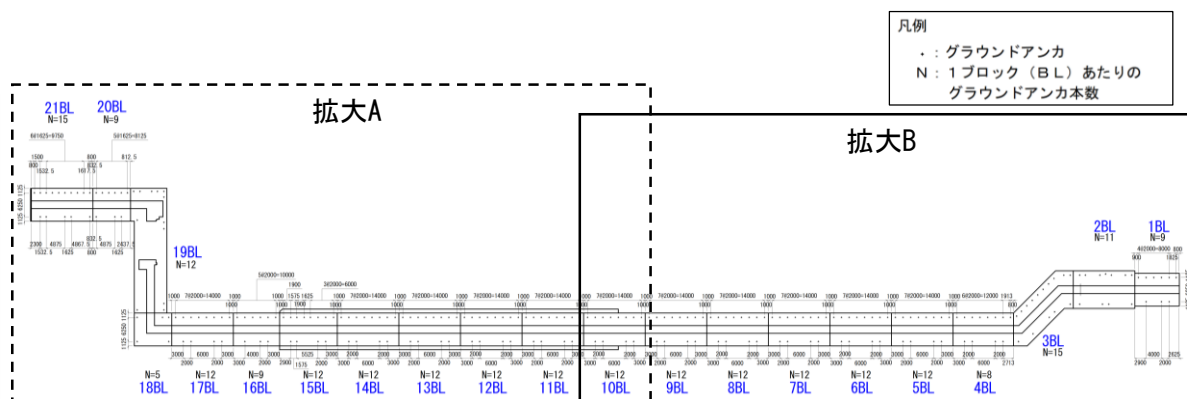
(1) 防波壁（逆T擁壁）のグラウンドアンカ配置図（全体平面図）
